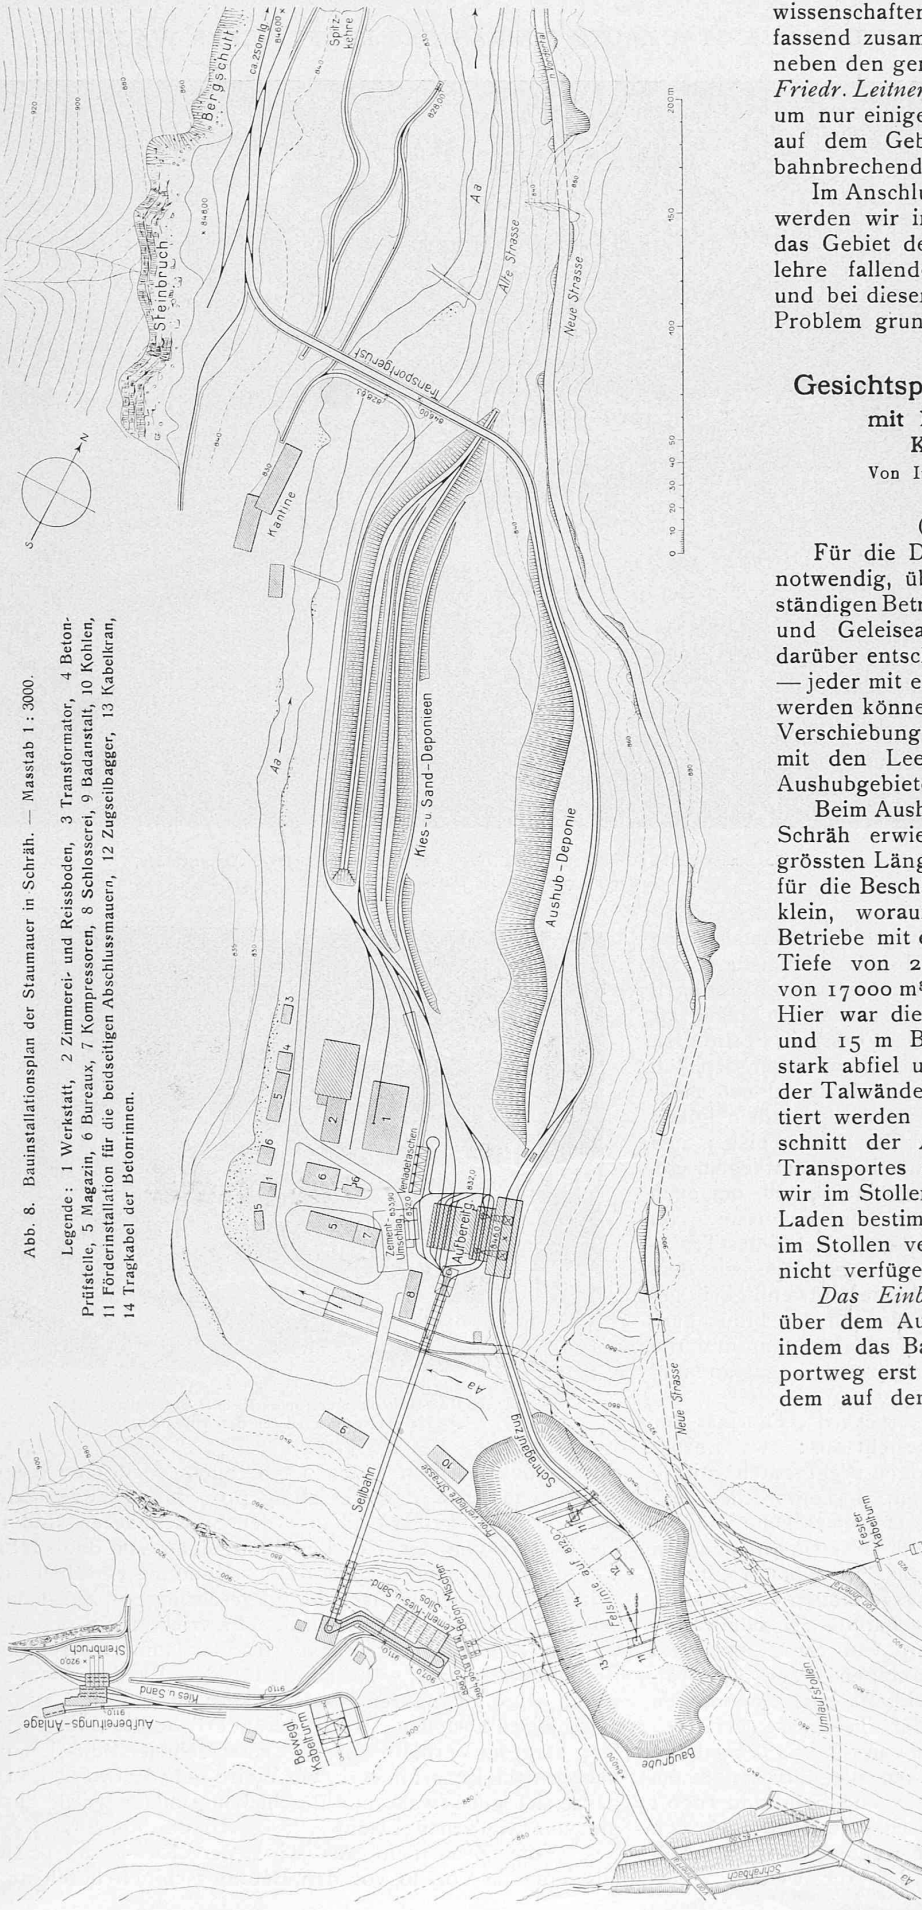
Bauinstallationsplan der Staumauer in Schräh. — Masstab 1 : 3000.
